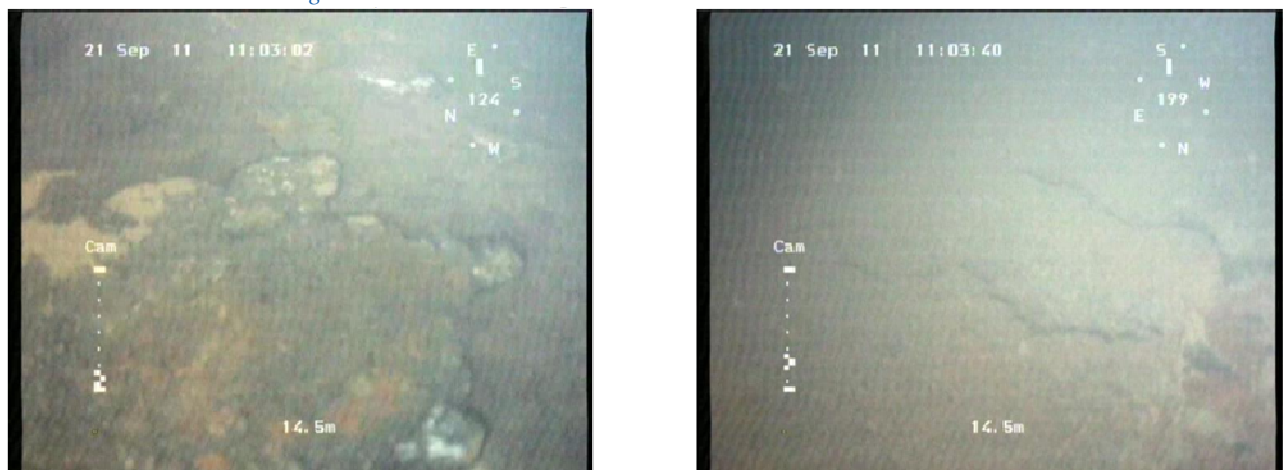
exemple de défaut sur une conduite (corrosion feuilletante)
